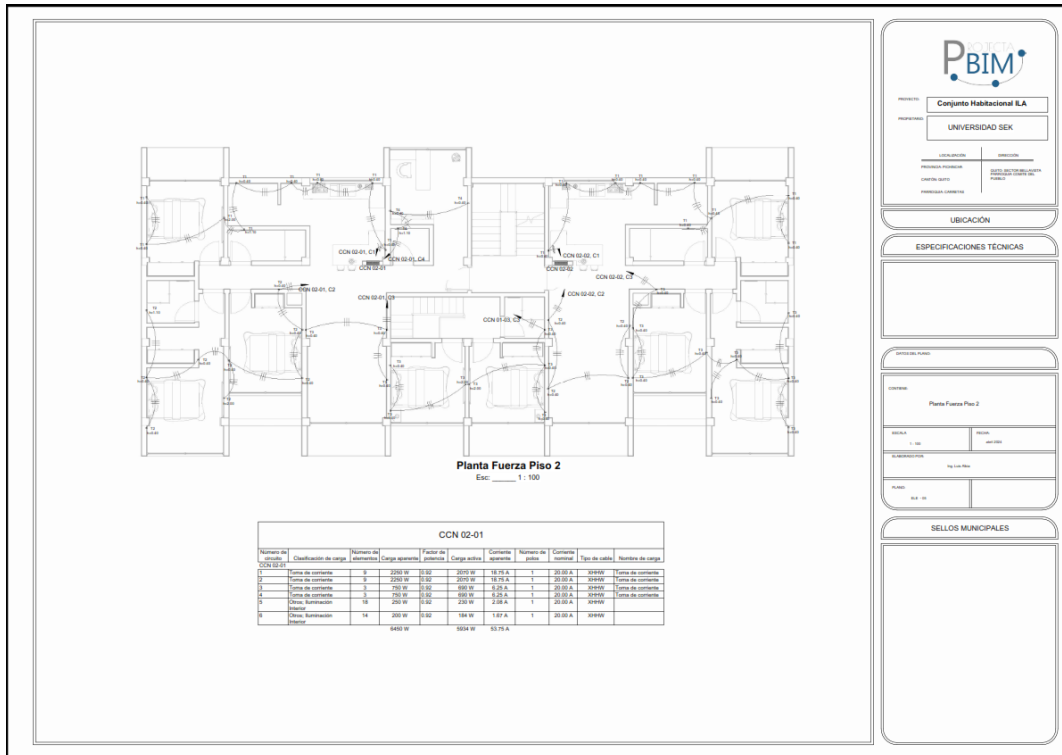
Plano Eléctrico Fuerza Piso 2 B1
